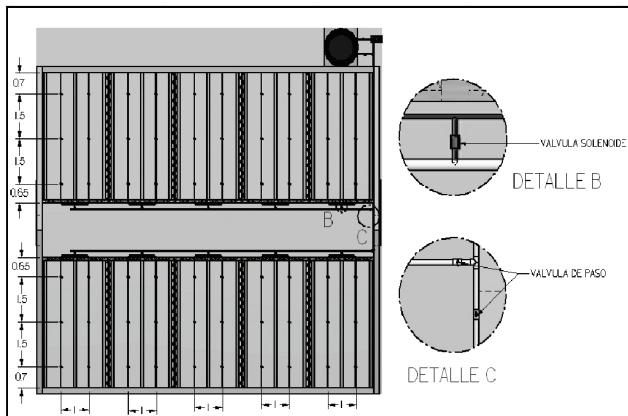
Distribución en planta de la “Cámara USCO – MADR, C1”
